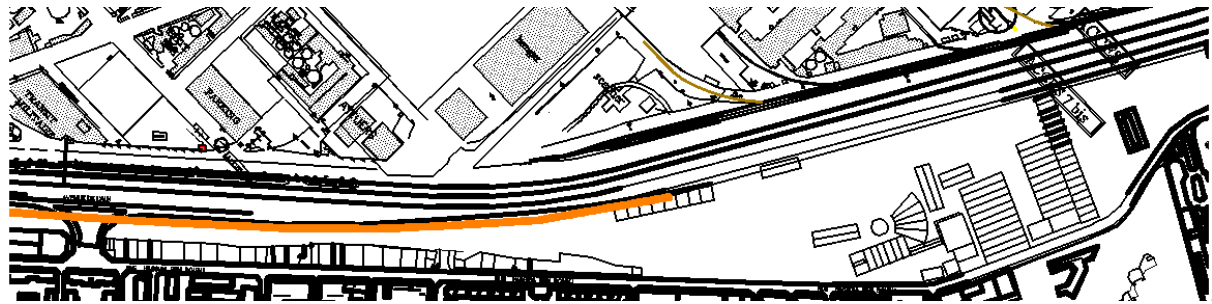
Vue en plan sur les ateliers de maintenances avant l'intervention
